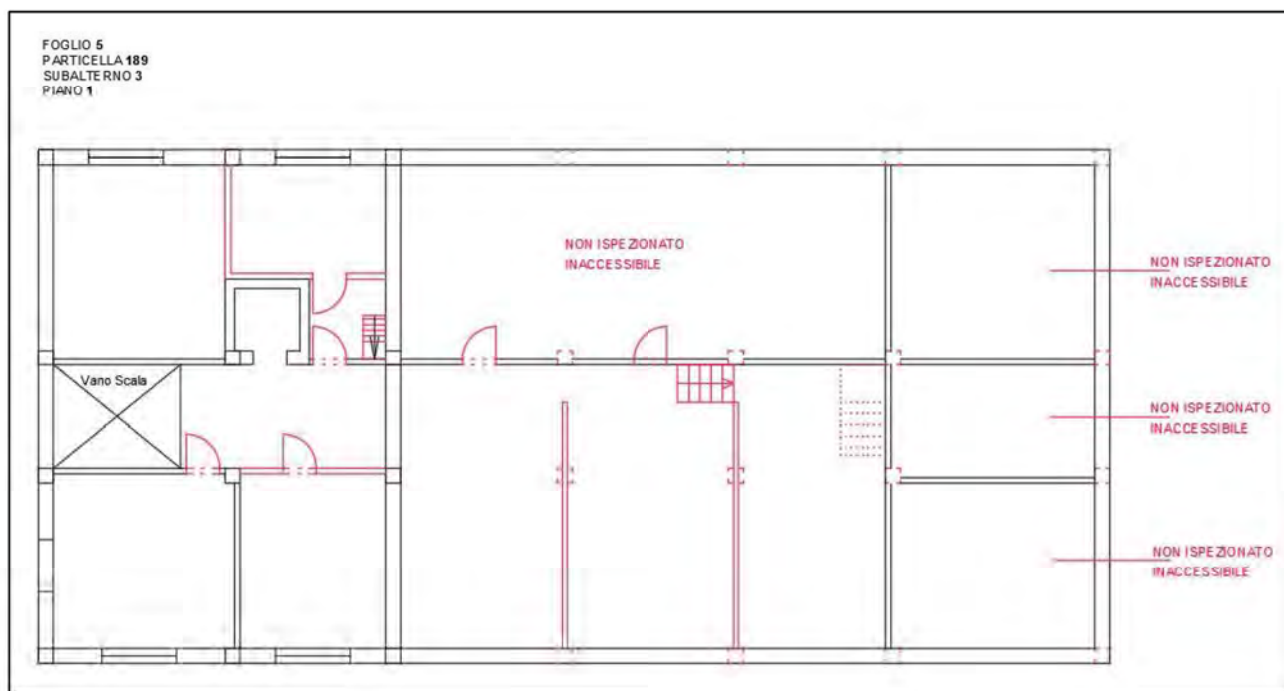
Planimetria piano primo - Difficoltà tra progetto in variante e stato di fatto rilevato durante il sopralluogo del 07.02.2019
